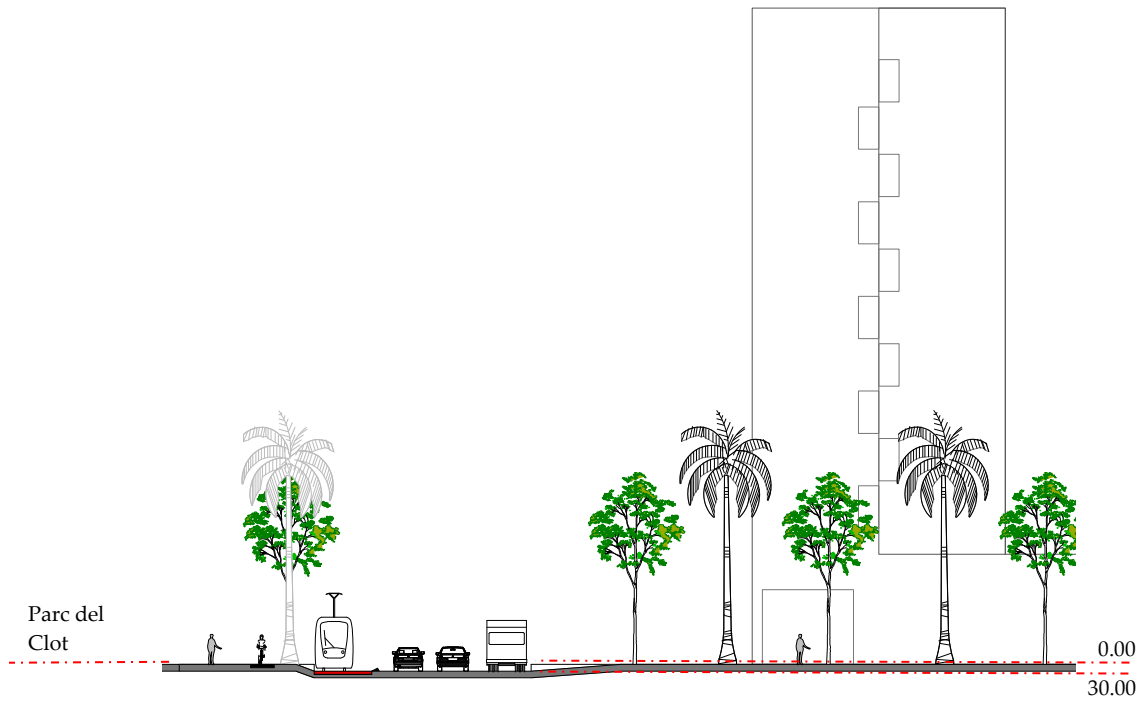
Sección longitudinal D-D, Rambla Poblenou. Fuente elaboración propia.
